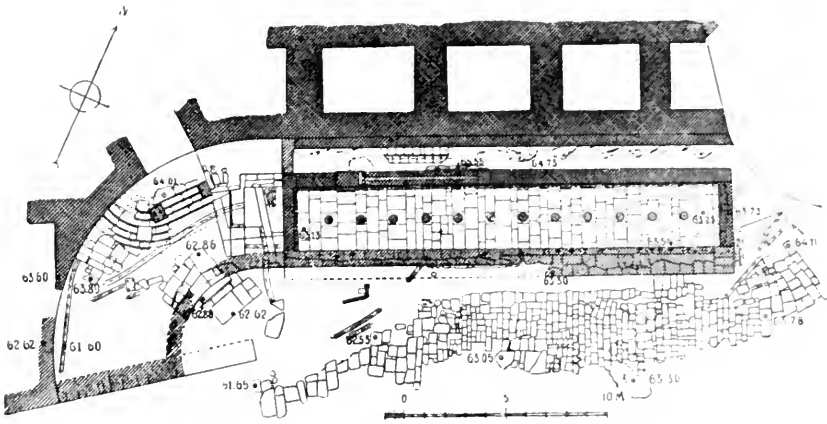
Grundriss des Brunnenhauses (jetziger Zustand).
